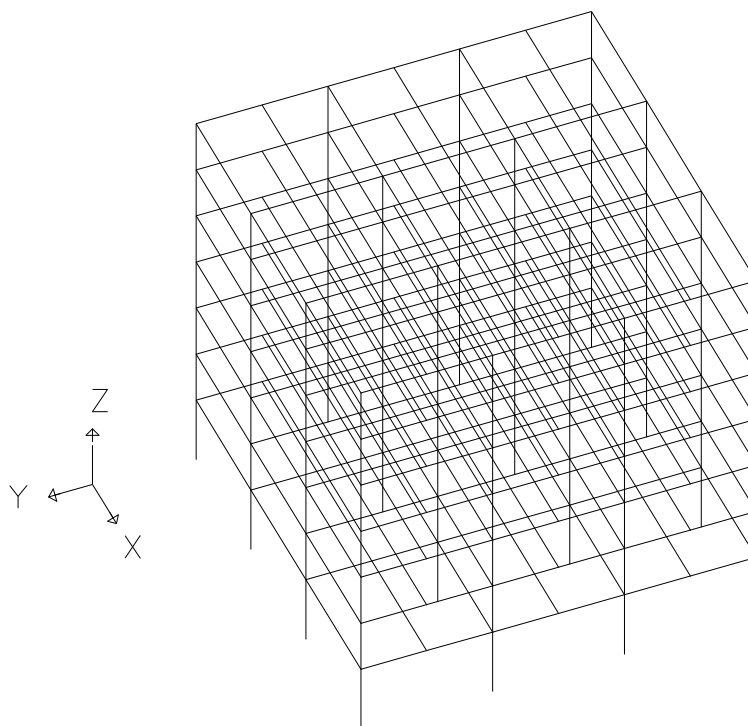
Modelo matemático tridimensional de las estructuras de 7 niveles
